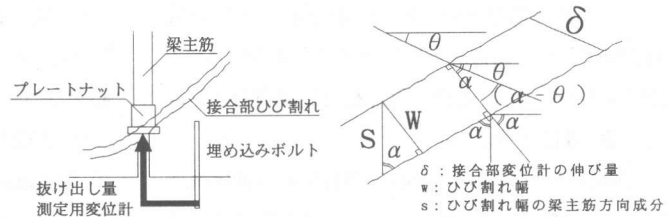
変位計計測状況 図-10 接合部ひび割れ幅計算図
